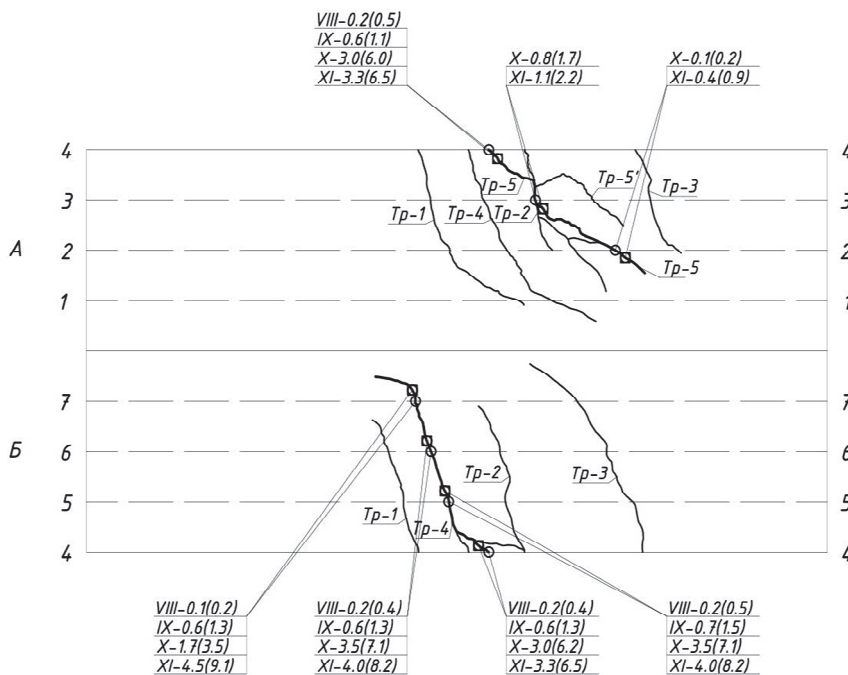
Раскрытие трещин в экспериментальной железобетонной конструкции четвертой серии IV-БВ-КО-410 (2):
